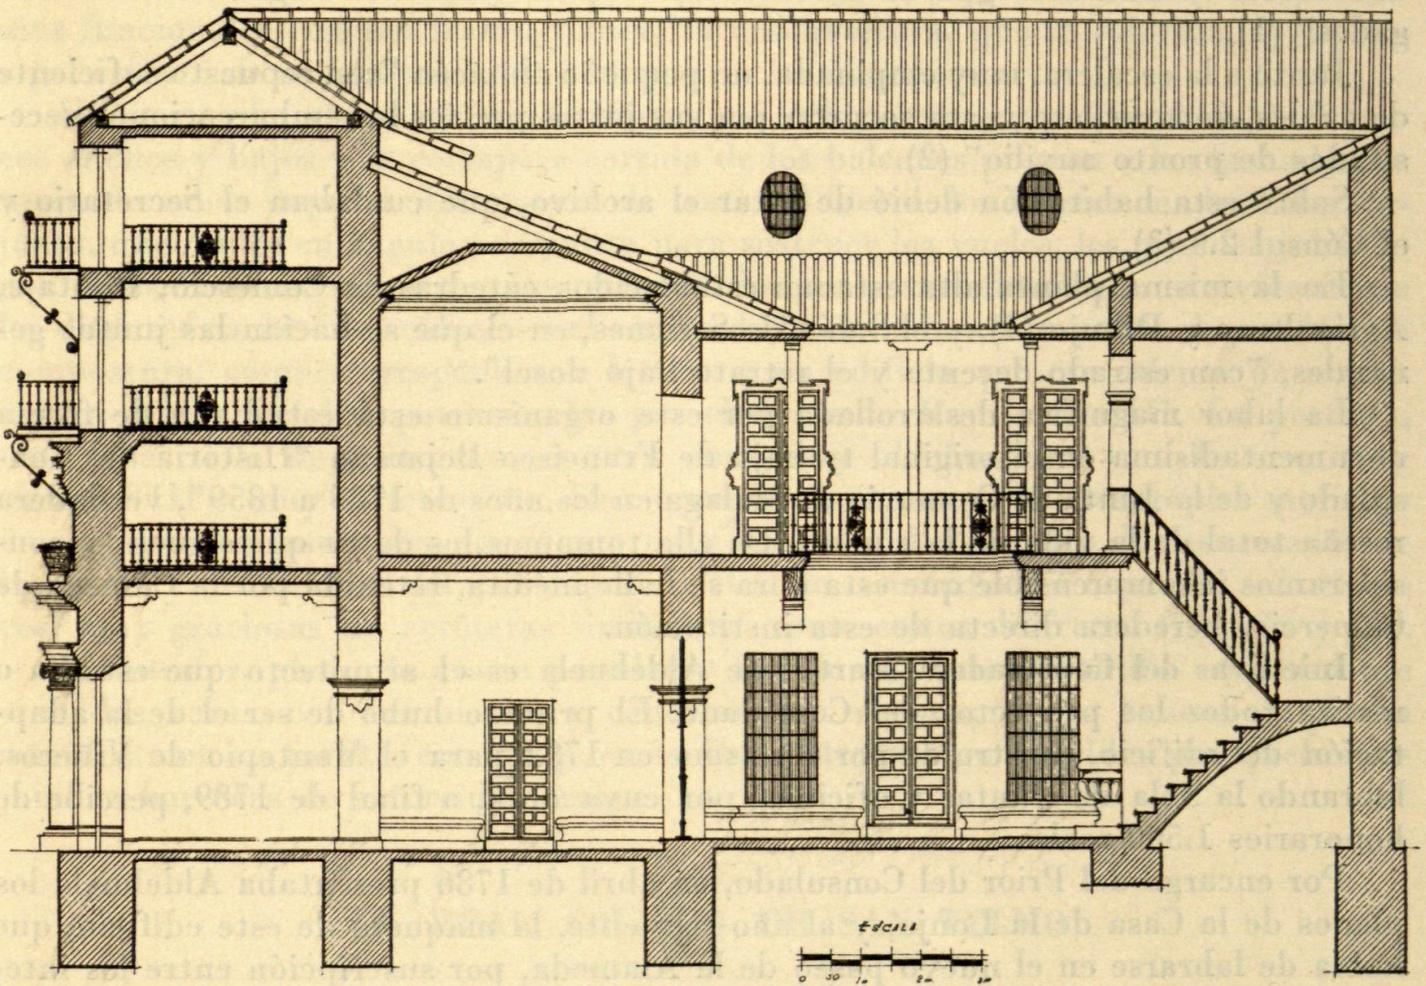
Málaga. Casa del Montepío. Sección longitudinal donde se advierte la forma y decoración del patio.
